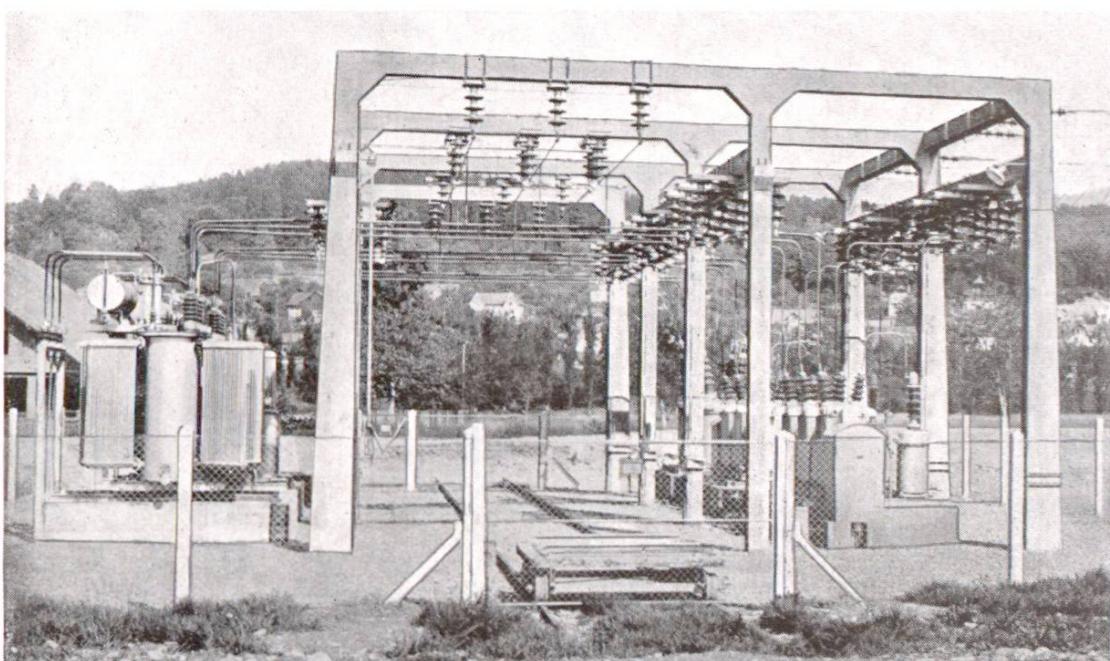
Station de couplage en plein air des Fabriques de ciment Jura, à Aarau
